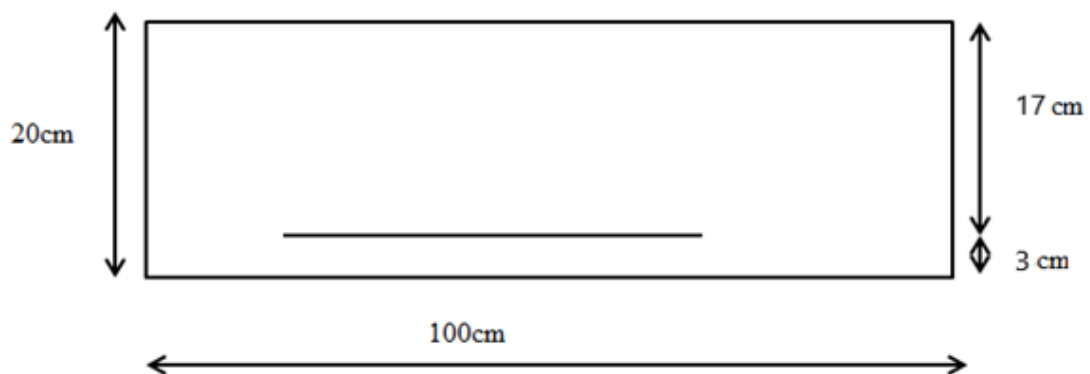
coupe schématique sur la section à prendre dans les calculs
